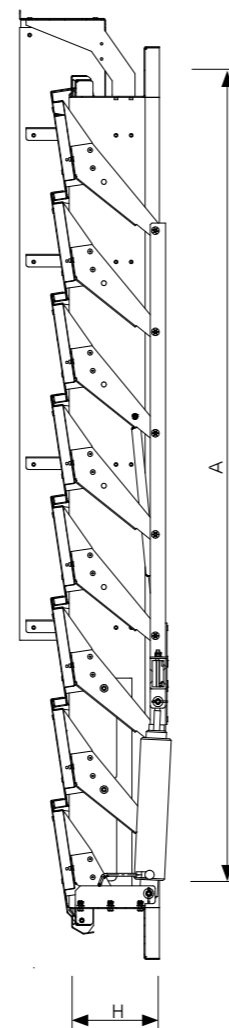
Schnitt A-A durch einen Lamellenlüfter mcr LAM in geschlossener Position (Dacheinbau)
